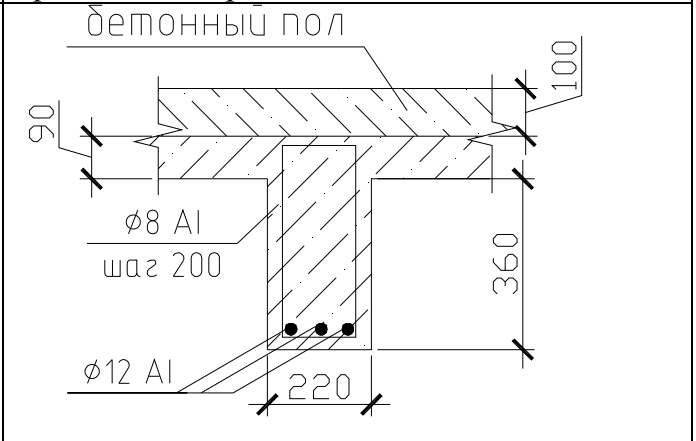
Второстепенная балка ж/б перекрытия фойе над первым этажом в осях «1-7/А-Д»
